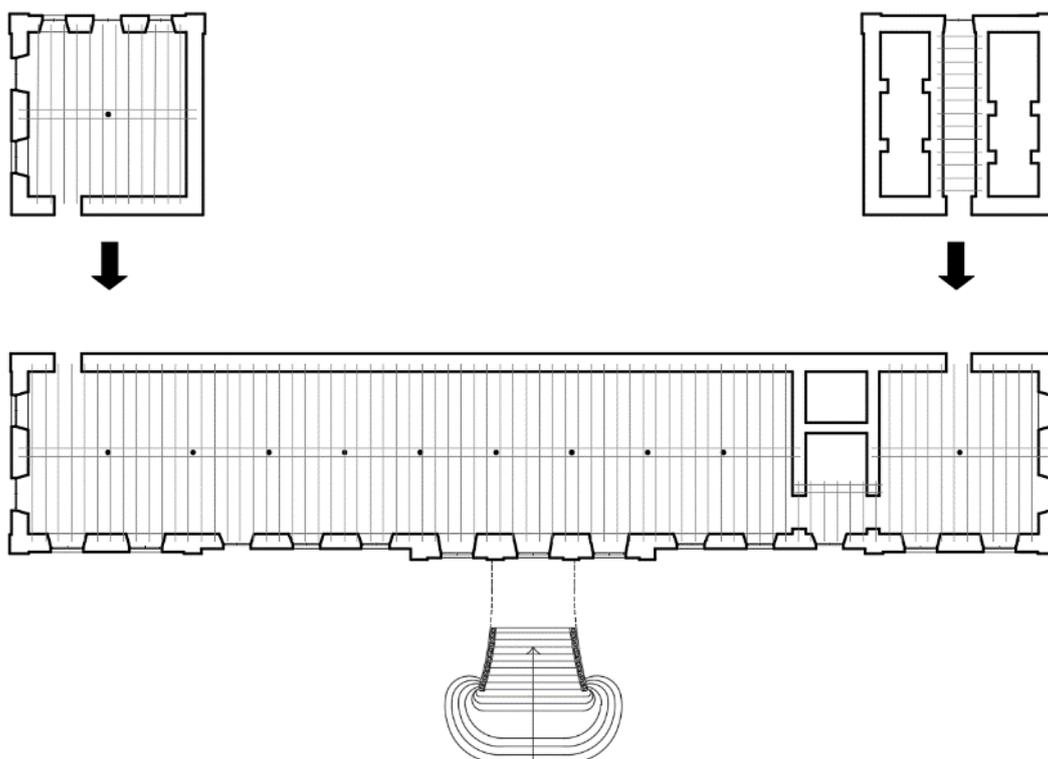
Planta baja. Esquema estructural. Organización de los volúmenes adosados.
